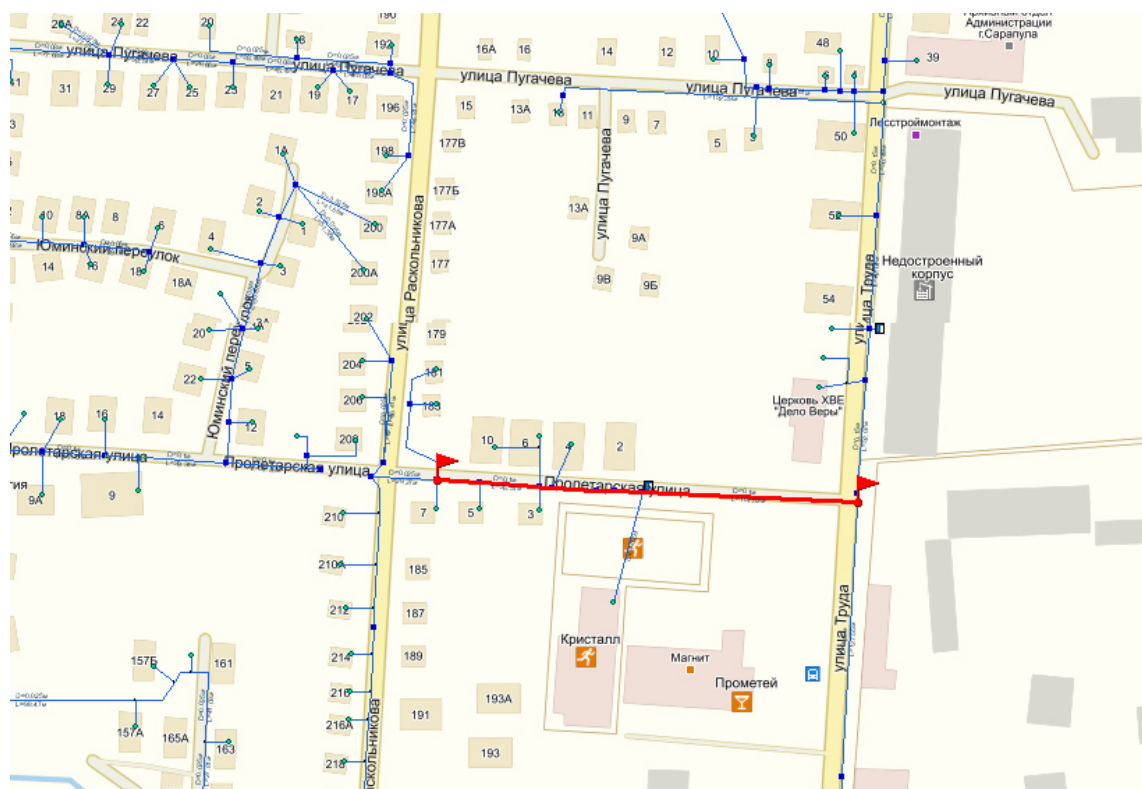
Участок водопроводной сети от ПГ-260 до ВК-4-23-86-7
